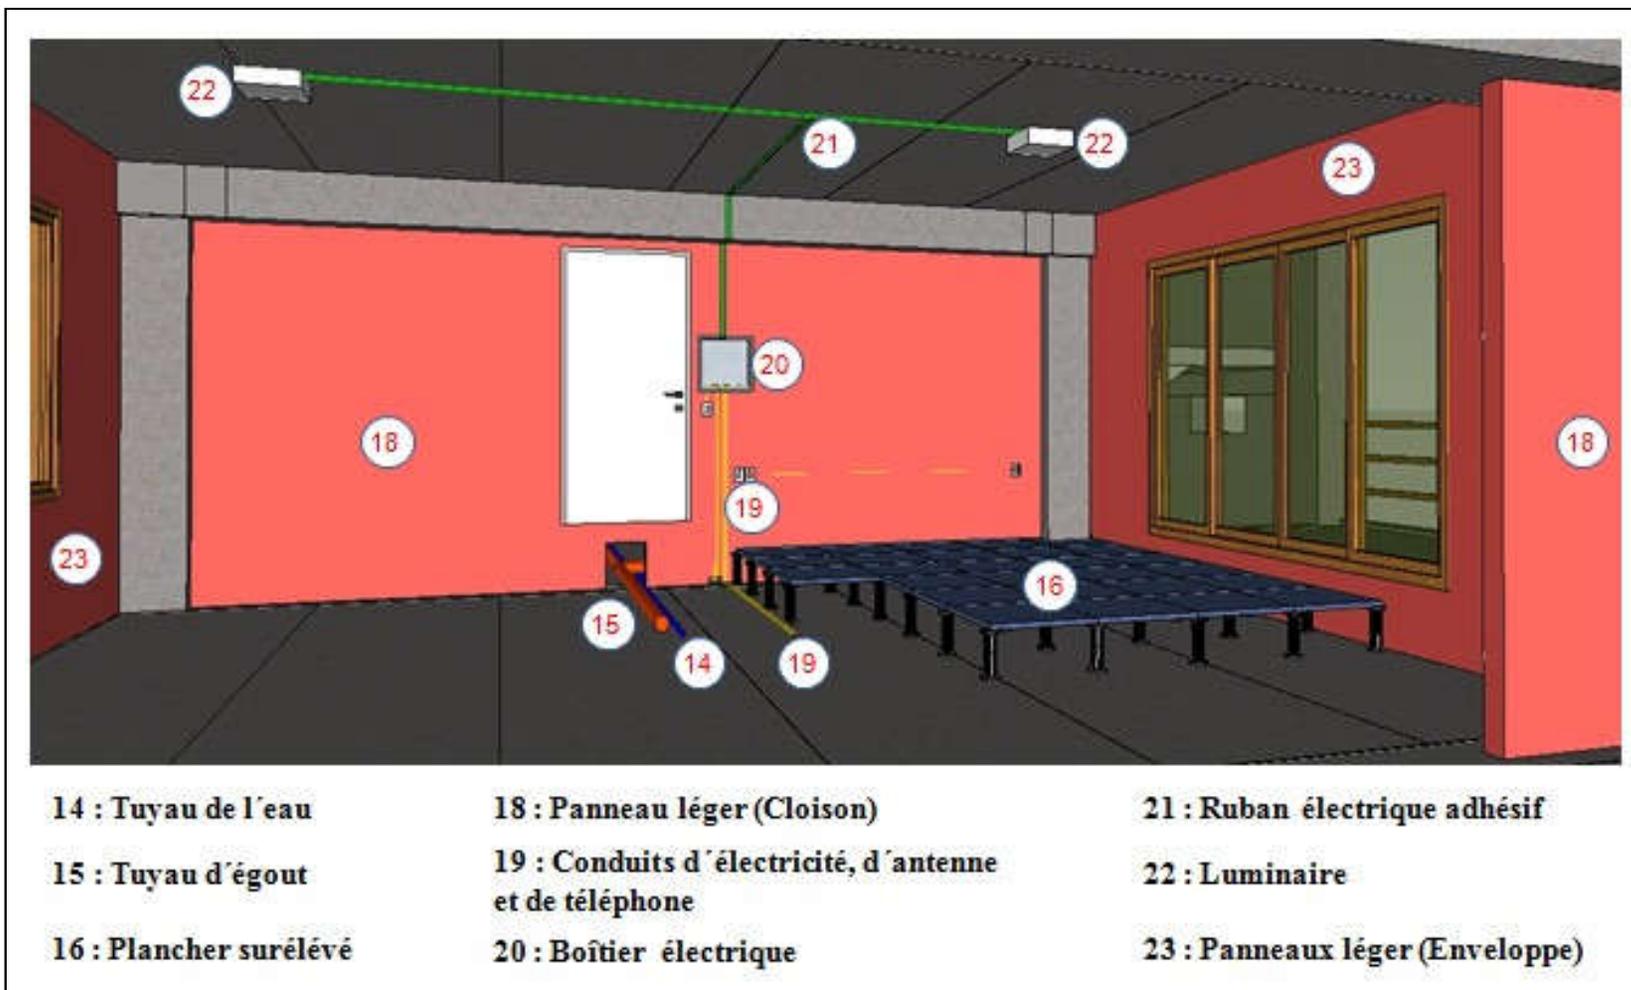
Perspective de la zone servie du bâtiment en poutre et colonne.
